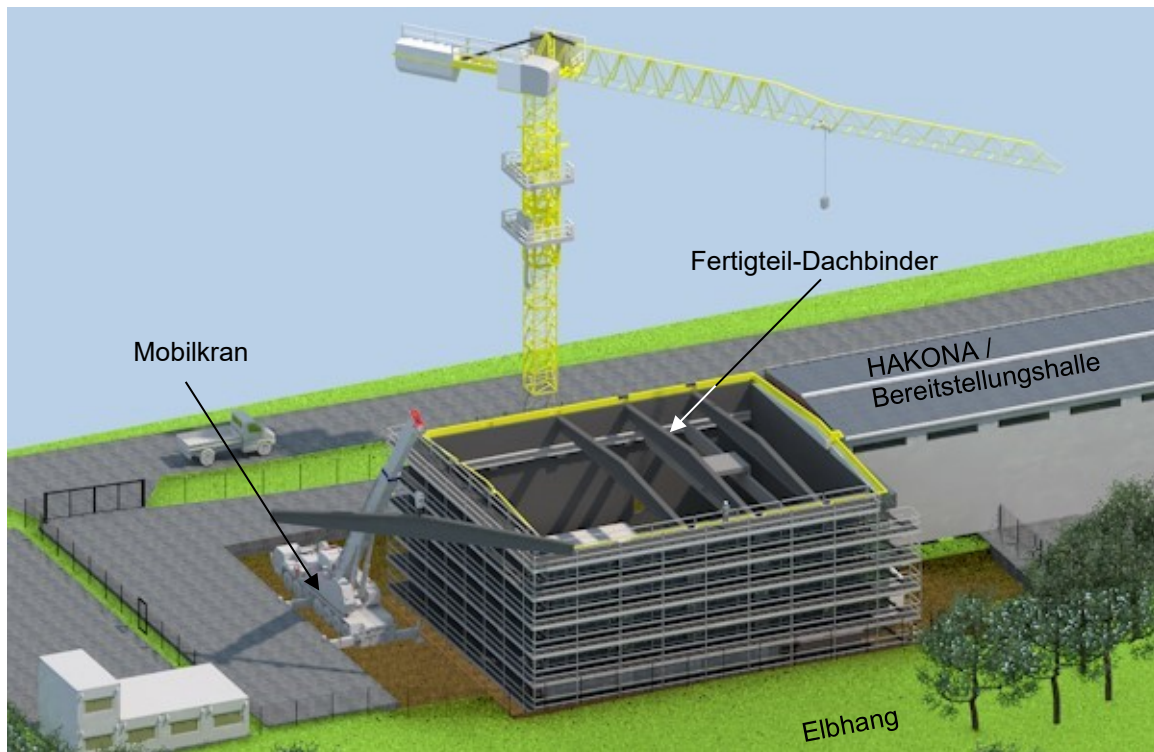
Herstellung Dachkonstruktion der Halle
